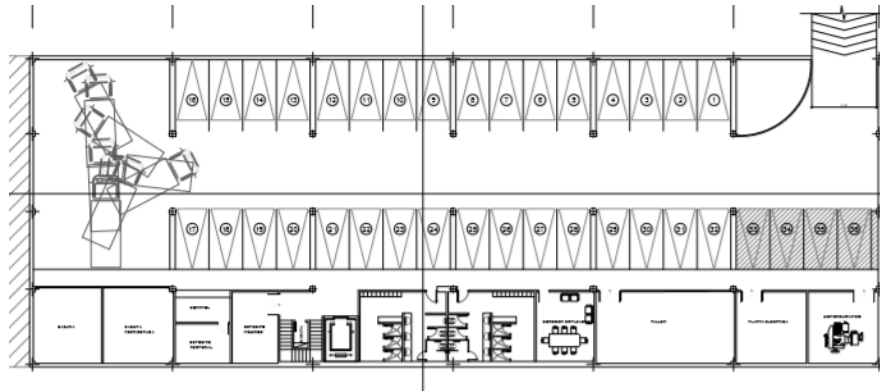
Planta Sótano Nivel -4,00m. (2020)
